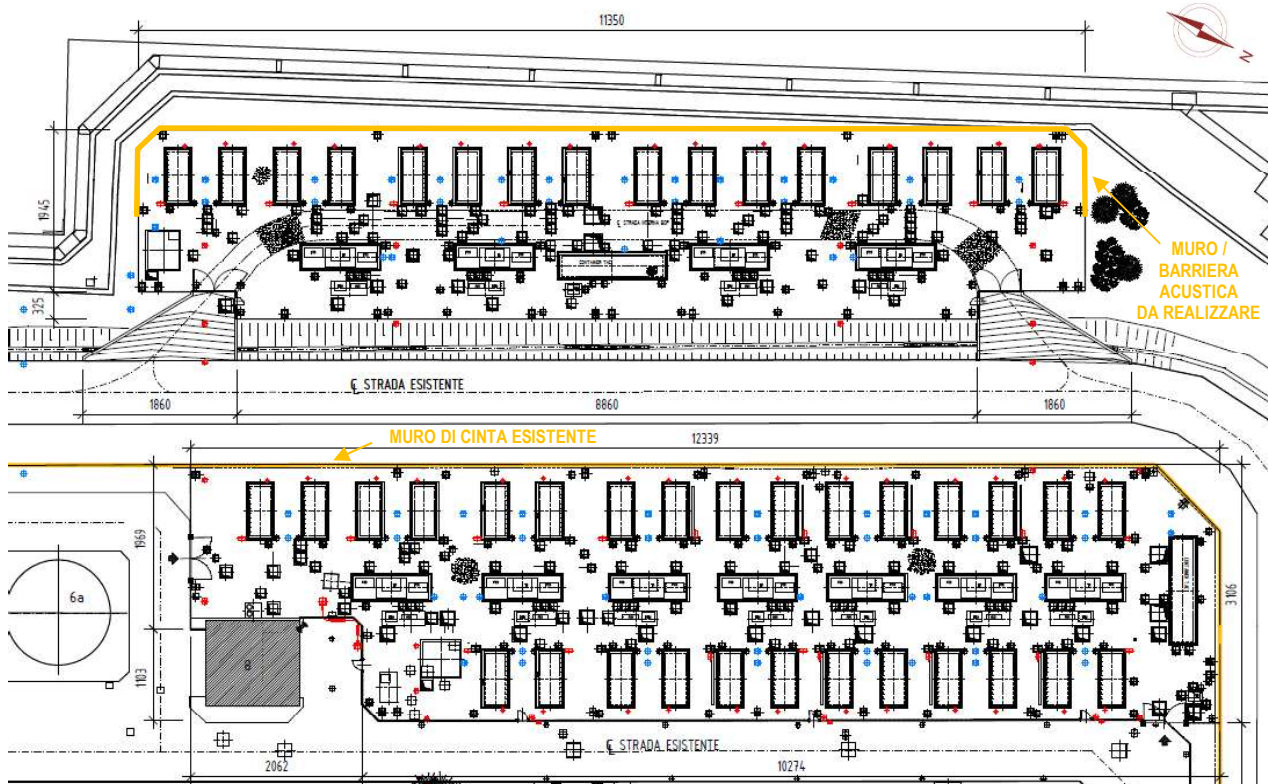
Layout dell'impianto BESS: dettaglio dell'area isole
